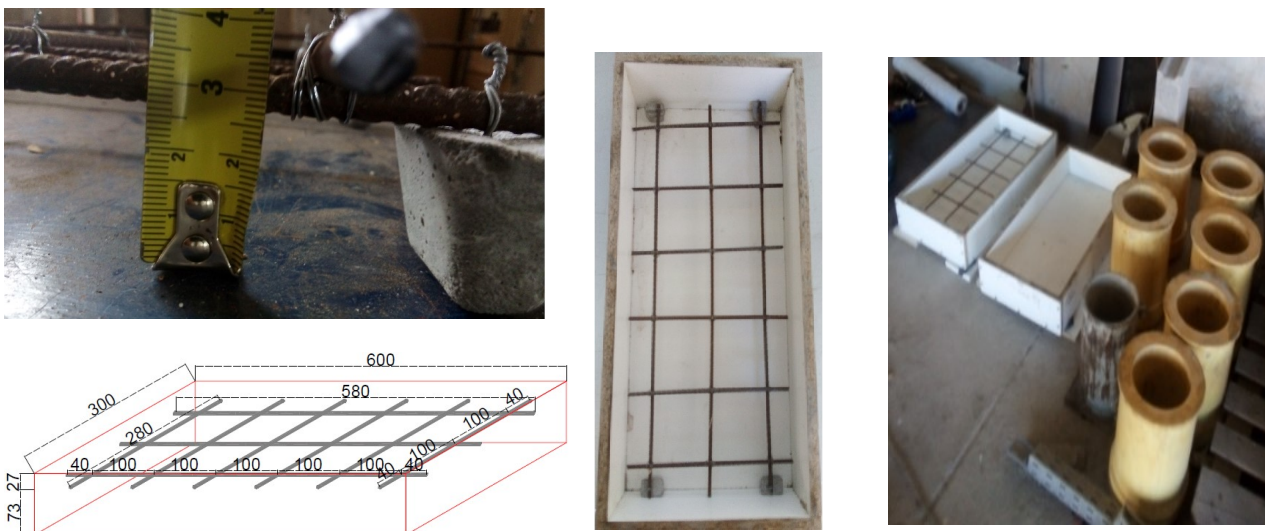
Disposição da armadura dos moldes prismáticos e cilíndricos utilizados para elaboração dos provetes.
